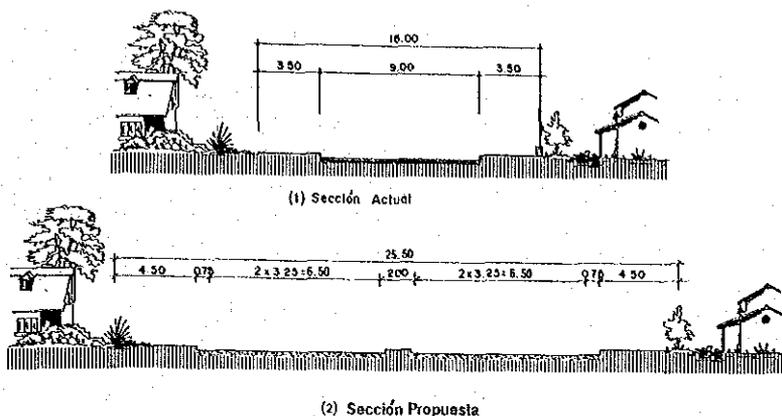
SECCION PROPUESTA DEL PASAJE RAPIDO ESPAÑA (BYPASS)
